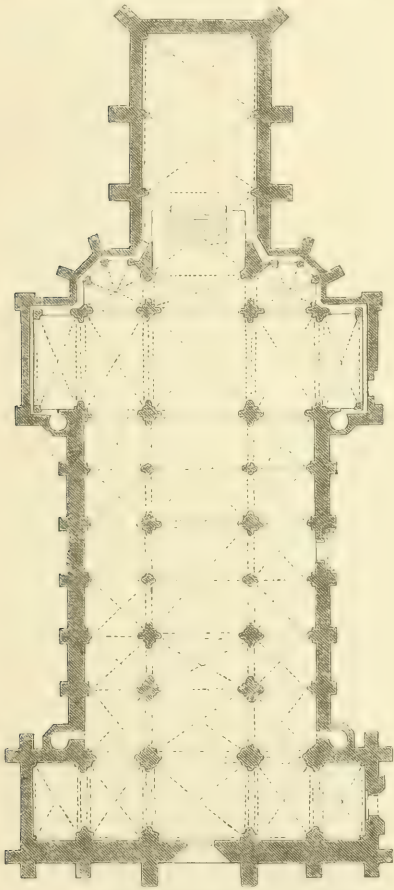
Grundriss des Münsters zu Schlettstadt.
